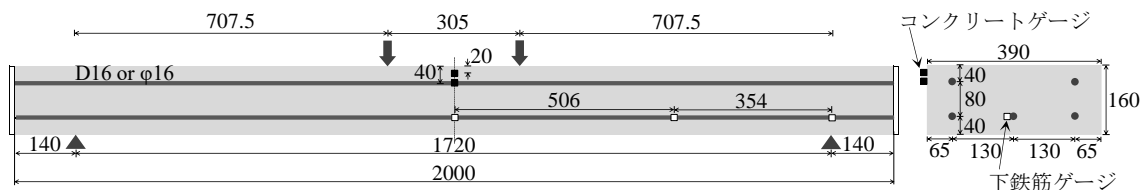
RCはり供試体の形状寸法, 配筋状況, ひずみゲージ設置位置
